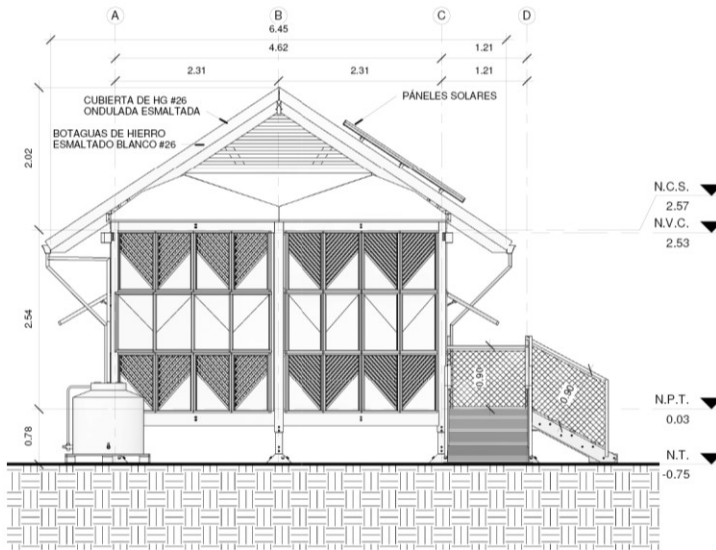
Lámina 04, planimetría de tipología A.<sup>303</sup>
